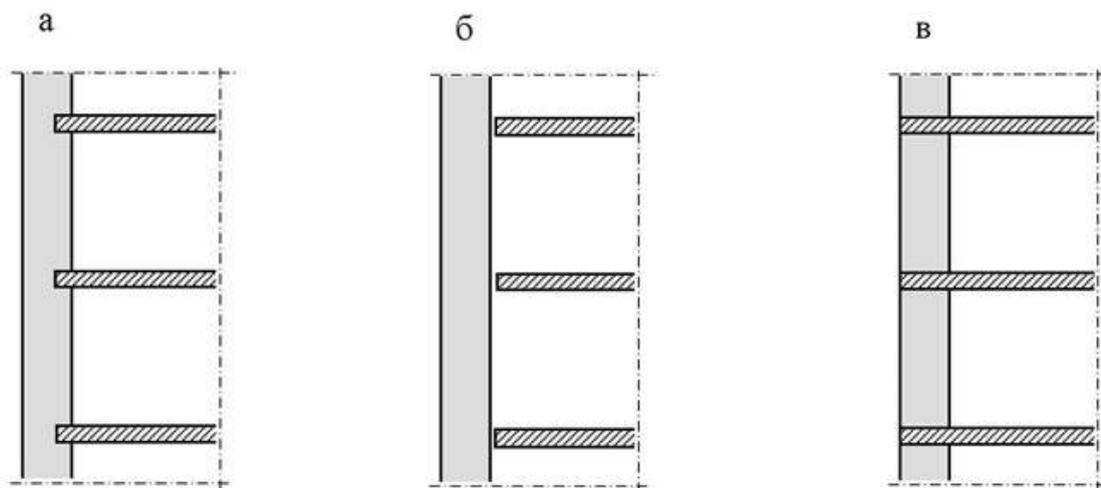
Типы наружных стен по восприятию вертикальной нагрузки
